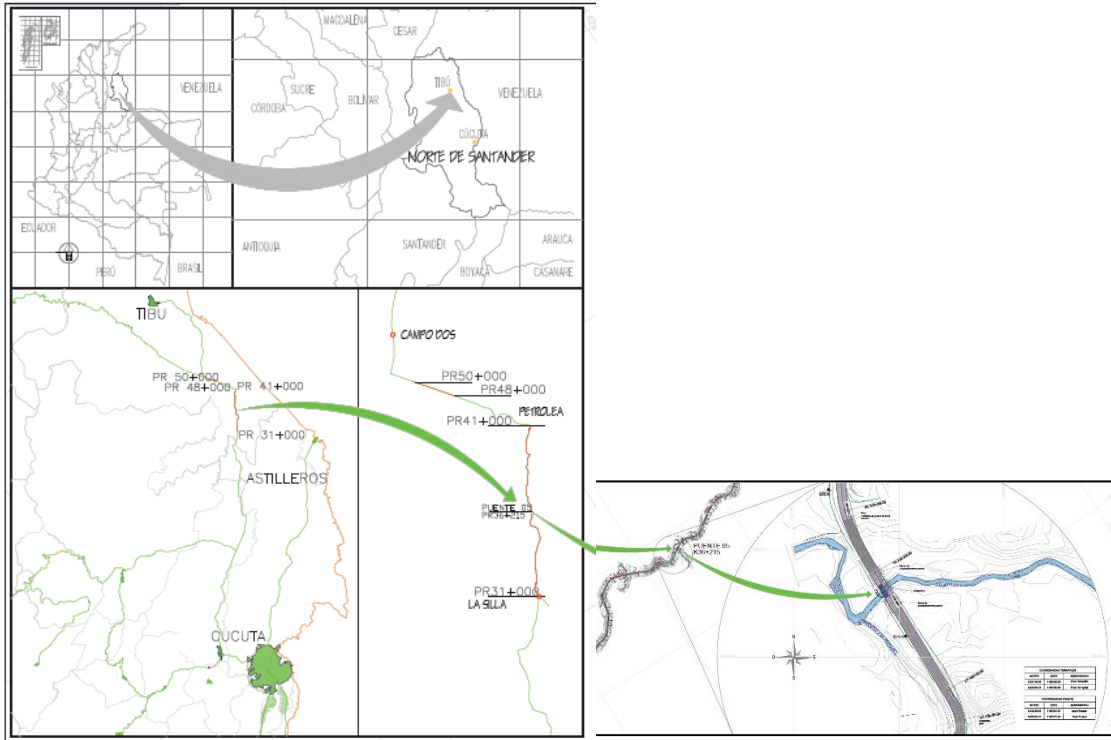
Planta general de localización de proyecto Tramo vial K35 + 910 – K36 + 315 Puente 5, Vía Astilleros – Tibú, en el departamento de Norte de Santander.
